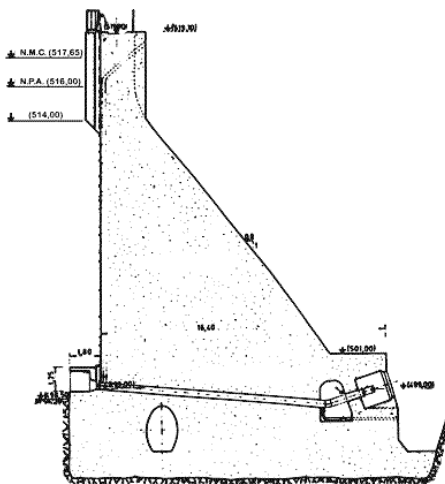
Corte transversal da barragem de Penha Garcia
